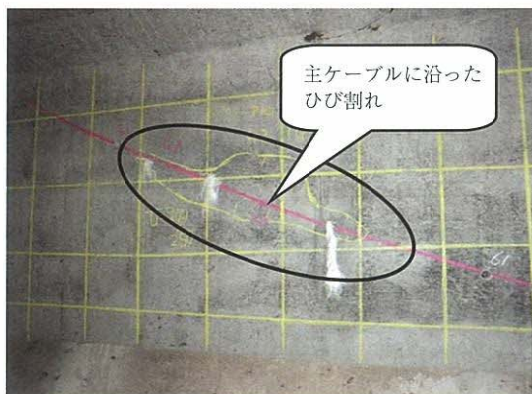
PCT 桁ウェブに発生したひび割れ
